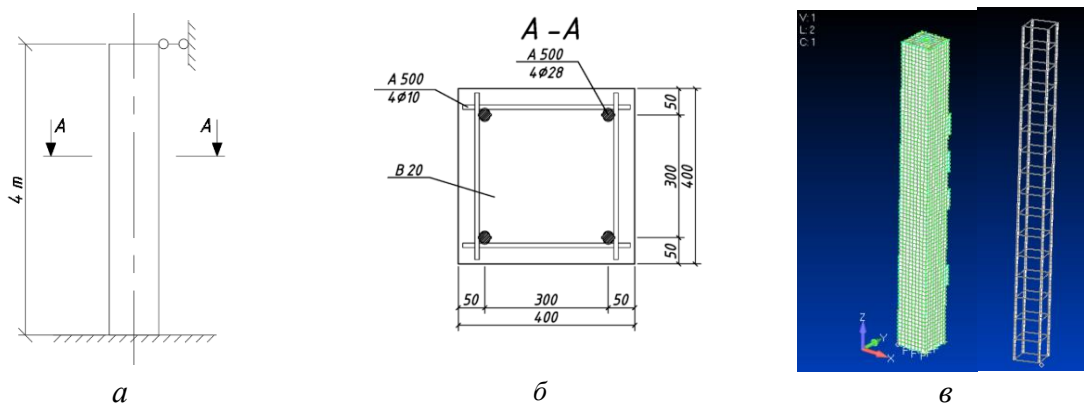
Расчетная схема колонны - а, поперечное сечение и схема армирования - б, конечно-элементная модель конструкции (вид бетона и арматуры) - в
